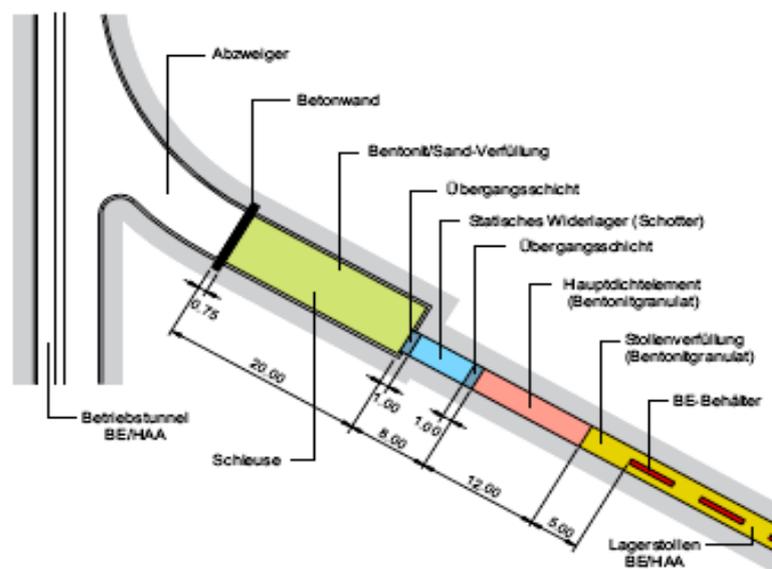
Design für den Verschluss einer Einlagerungsstrecke
